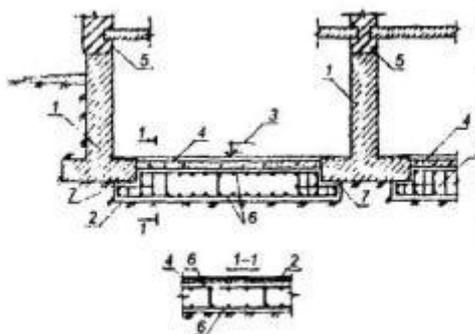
1 - усиливаемый ленточный фундамент; 2 - сплошная (прерывистая) плита; 3 - отметка поверхности пола подвала; 4 - уплотненный крупный песок; 5 - кирпичная стена; 6 - рабочая арматура плиты усиления; 7 - поверхность фундамента, подготовленная к бетонированию.
